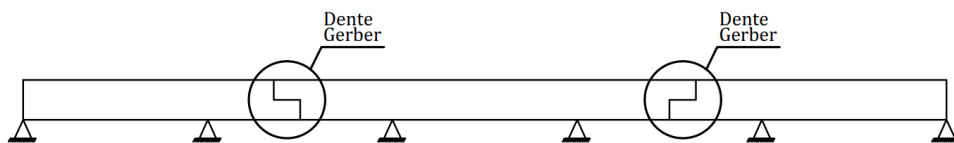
Ponte com múltiplos vãos em vigas isostáticas.
